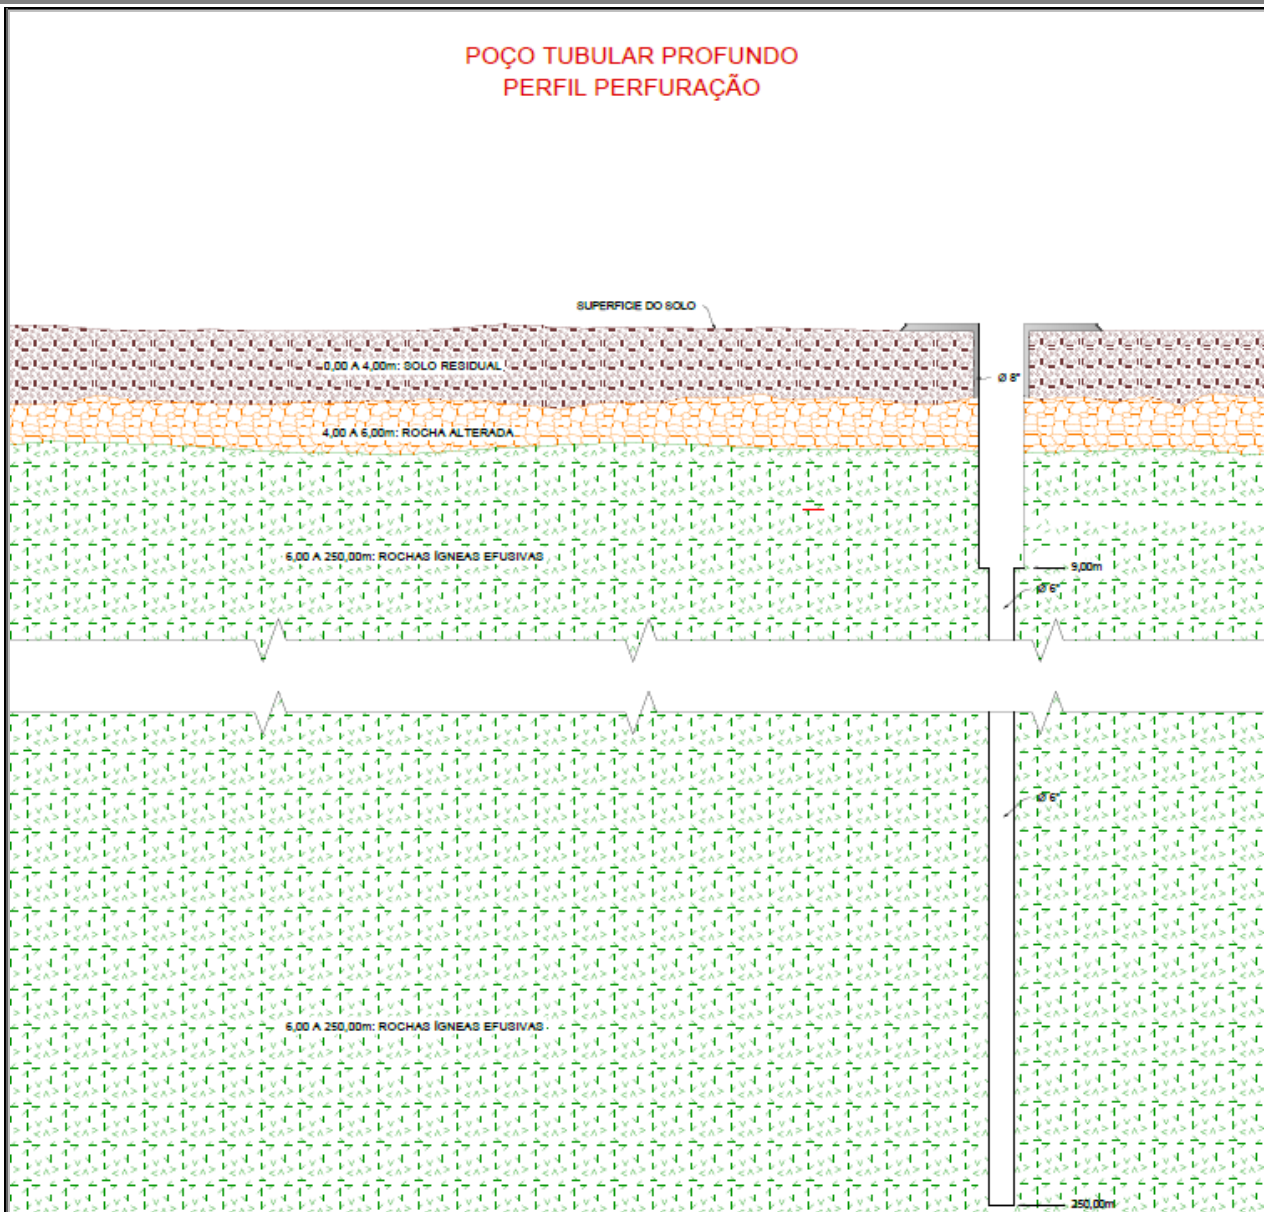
Perfil Perfuração do Poço. Simplificado do ANEXO 9.
